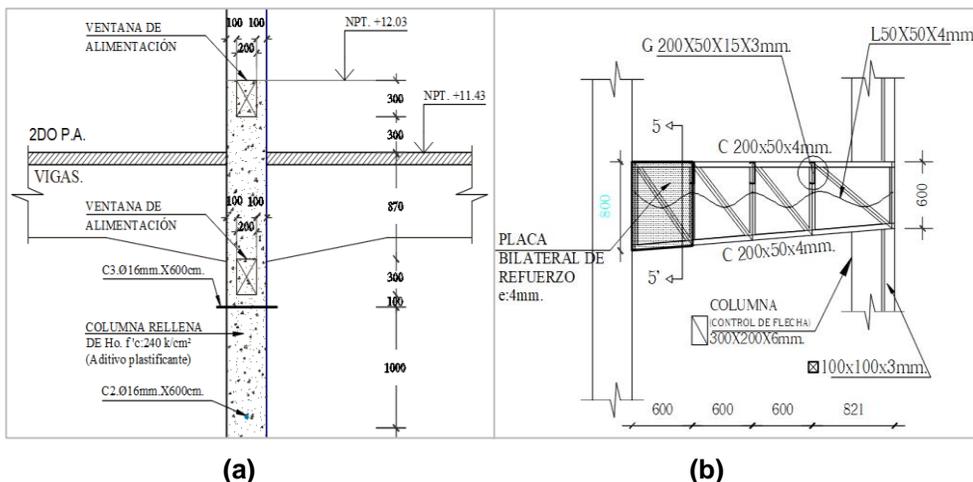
Propuesta ejecutada, (a) Relleno de columna con hormigón de 240kgf/cm². (b) Reforzamiento viga en celosía con placa bilateral y aumento de columna en volado.
